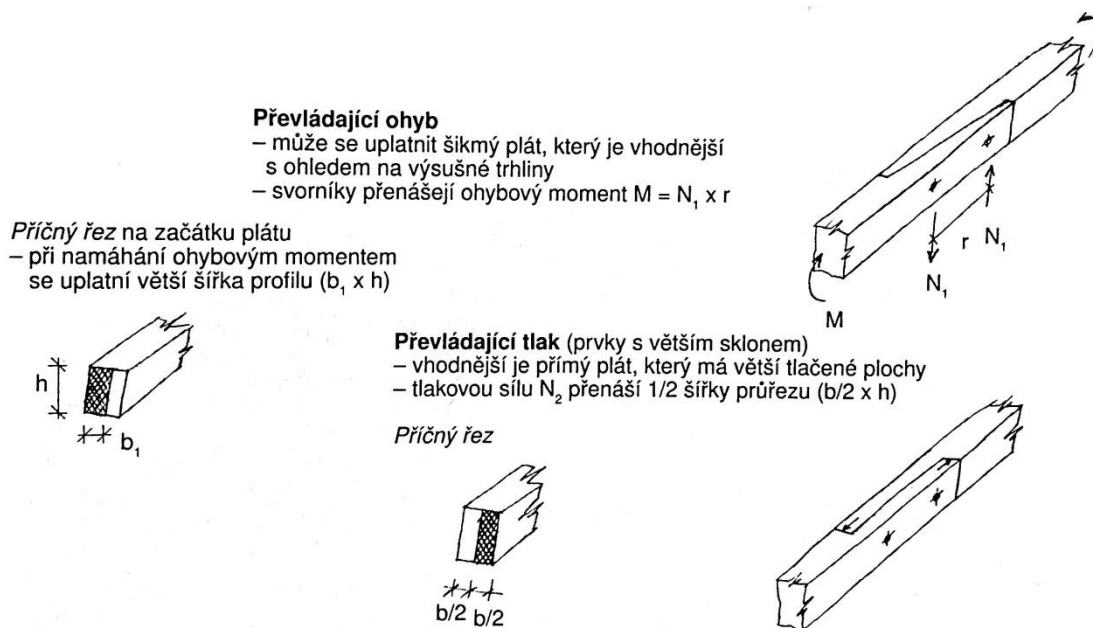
Nastavení ohýbaných prvků (vazné, stropní trámy)
